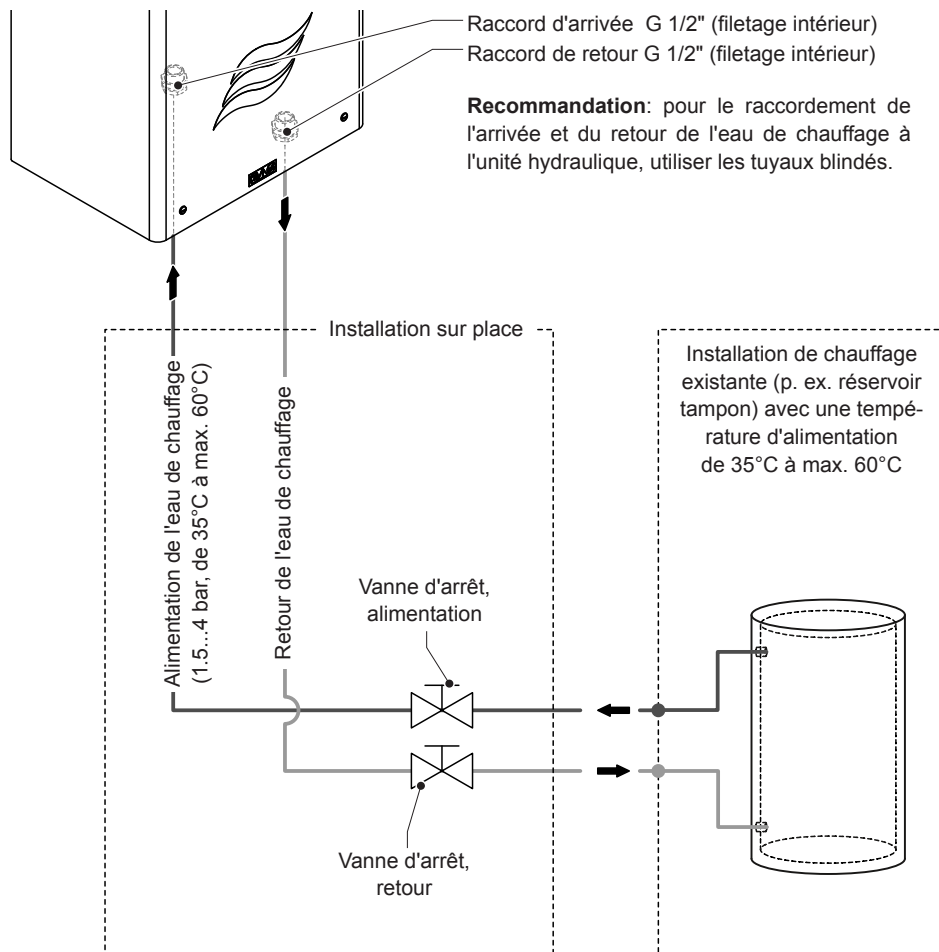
Installation du raccord de l'eau de chauffage pour la variante HW
